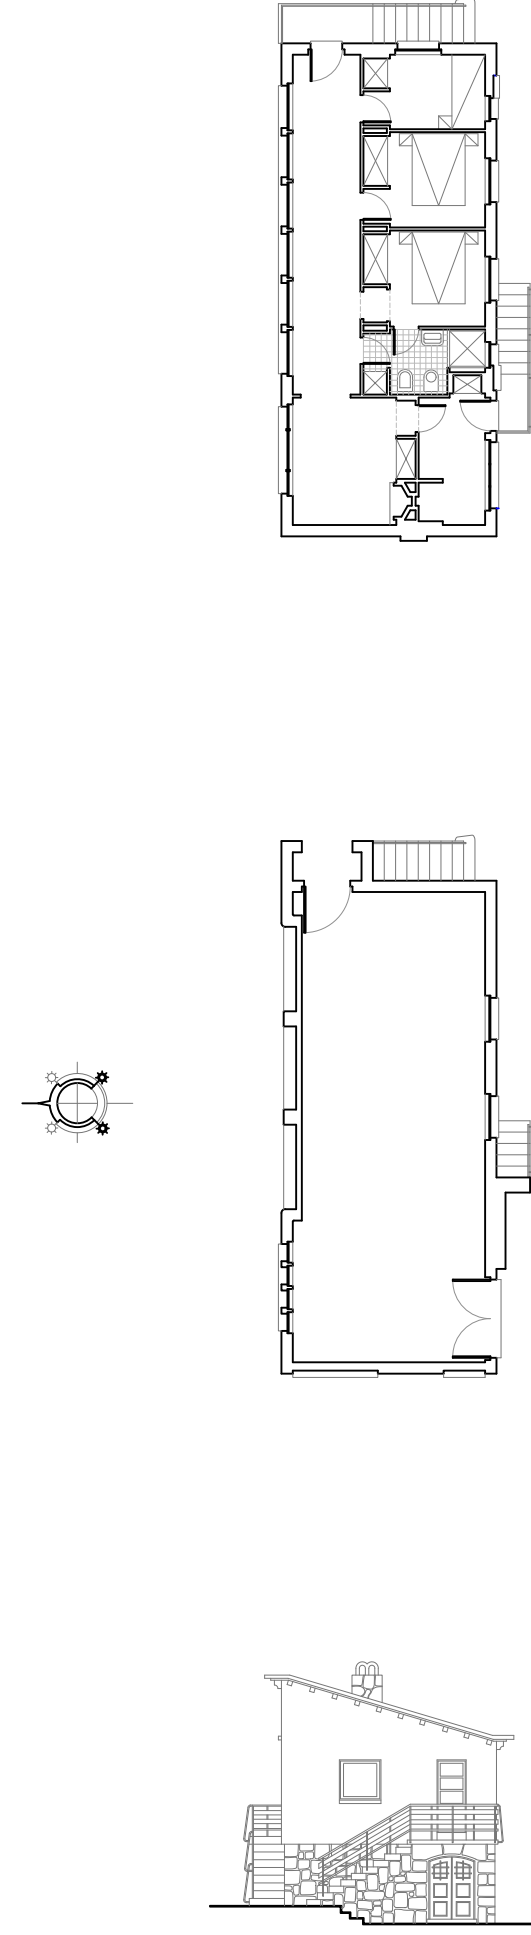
Planta de primeiro piso, planta de rés-do-chão e alçado poente da Casa Silva Meireles - escala 1.200.
